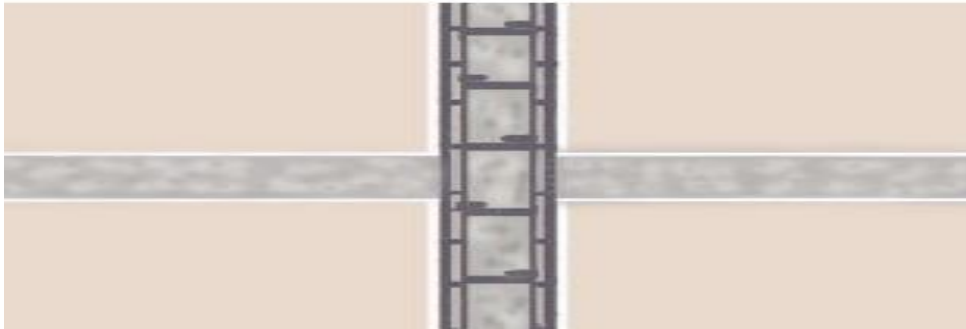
Limpiar las impurezas en la sección de la columna (Fuente: Silva 2014)
